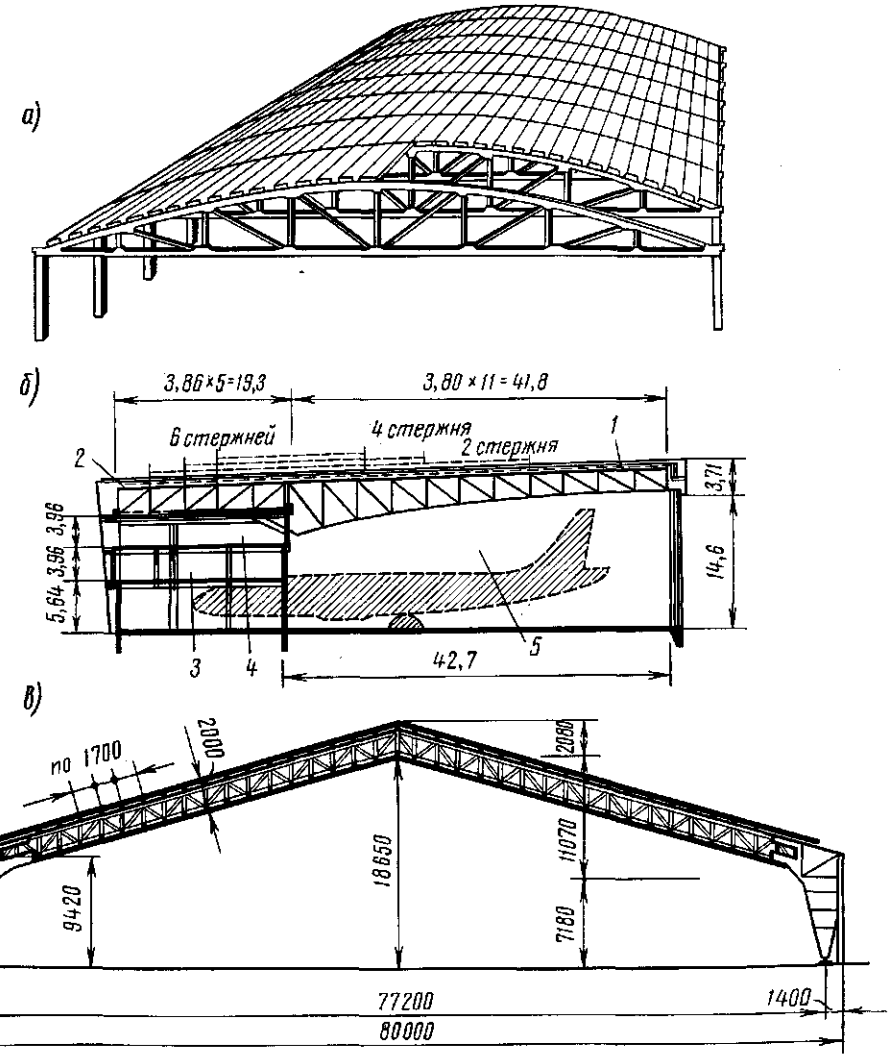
Большепролетные плоскостные покрытия: а — с железобетонными фермами пролетом 96 м; б — со стальными предварительно-напряженными фермами пролетом 42,7 м; в — с металлическими рамами пролетом 80 м
